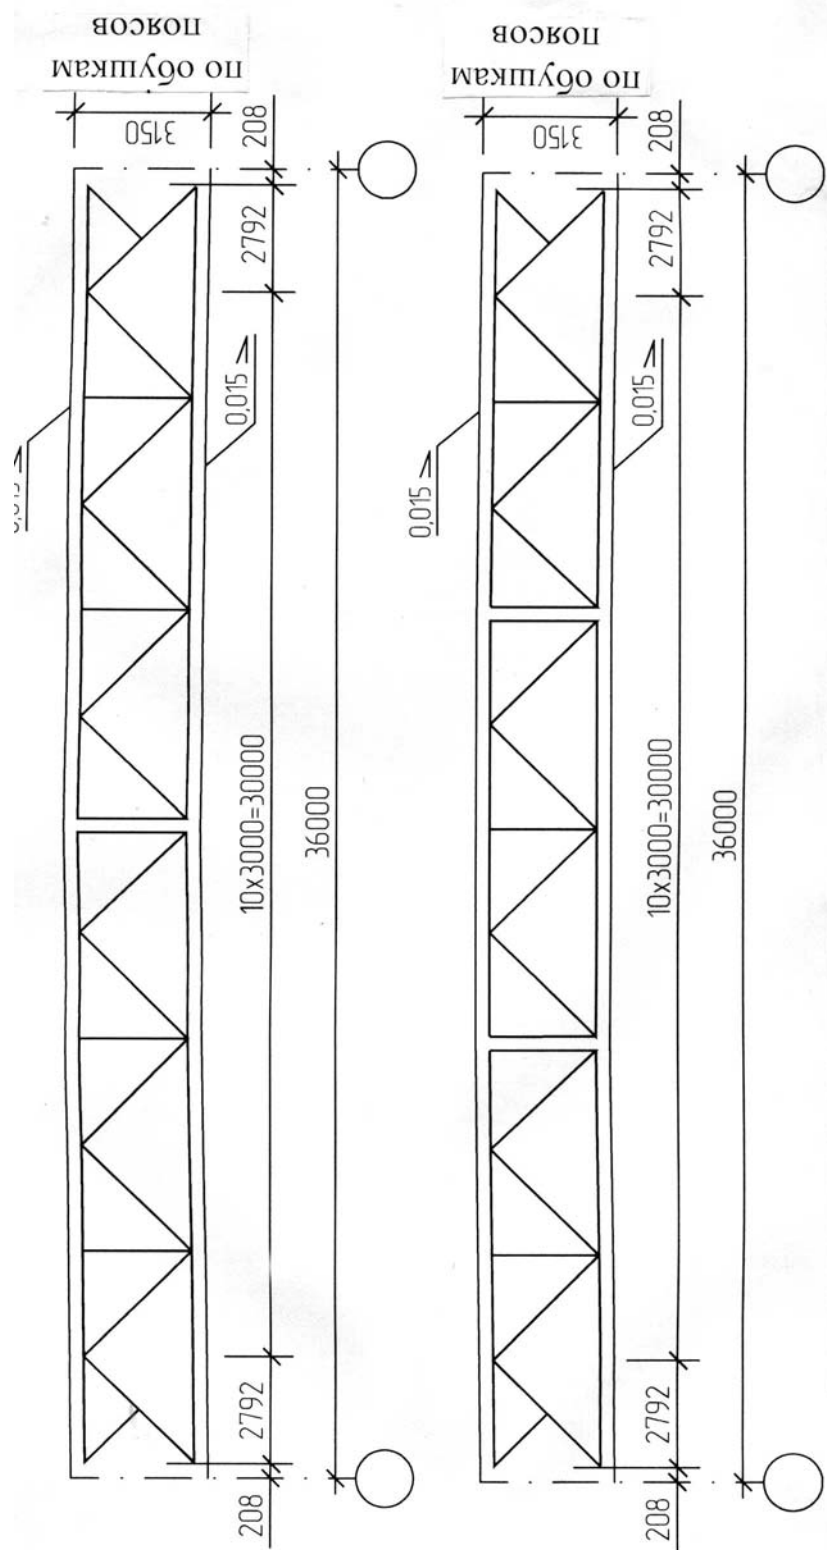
Схемы типовых стропильных ферм из парных уголков пролетом 36 м
